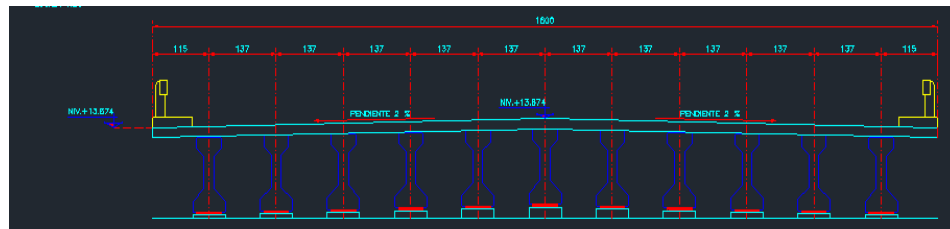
Sección transversal de la losa del claro y las 11 traveses
